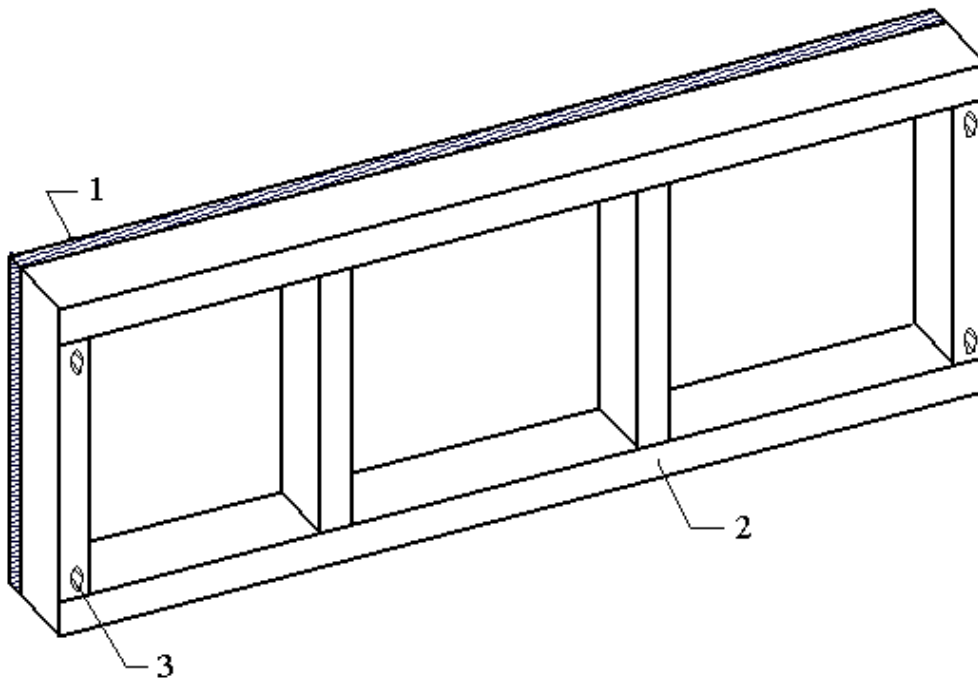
Щит опалубки: 1 – галуба из водостойкой фанеры; 2 – несущие элементы щита из доски; 3 – отверстия для установки тяжей
